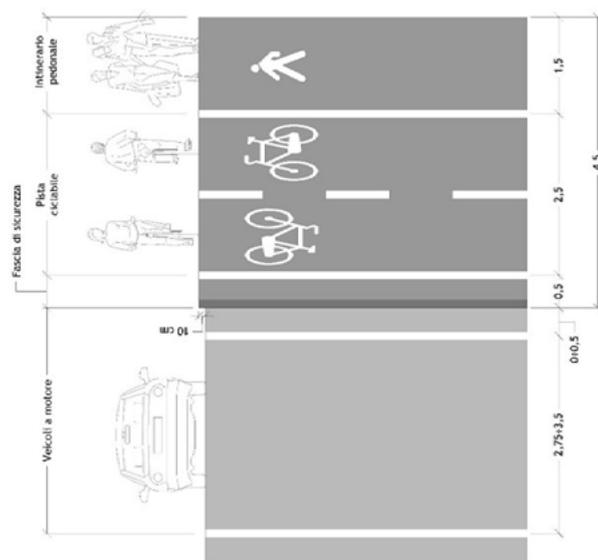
Sezione tipo: Pista ciclabile su corsia riservata sui marciapiedi
